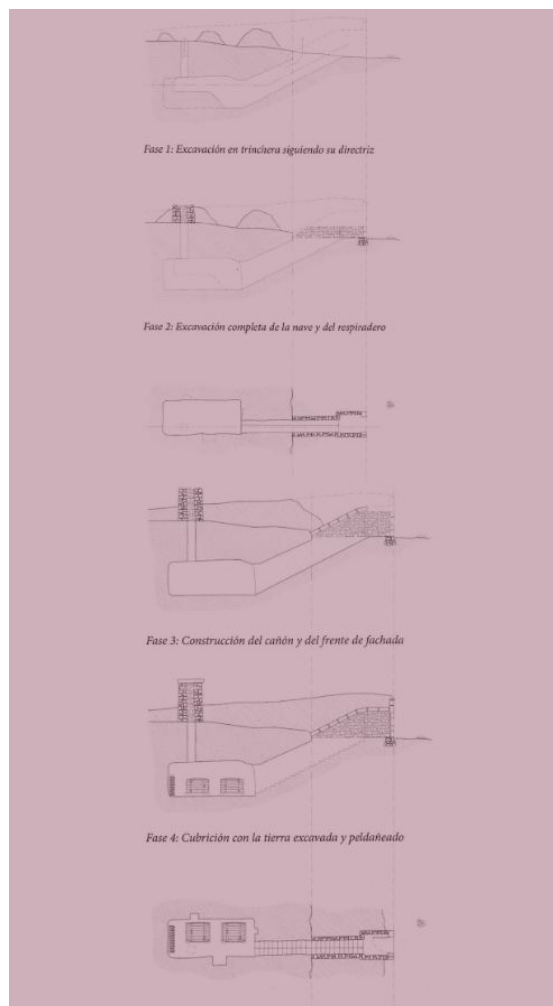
Esquema del proceso constructivo de una bodega tradicional excavada. (Fuente: Jové, 2021).
